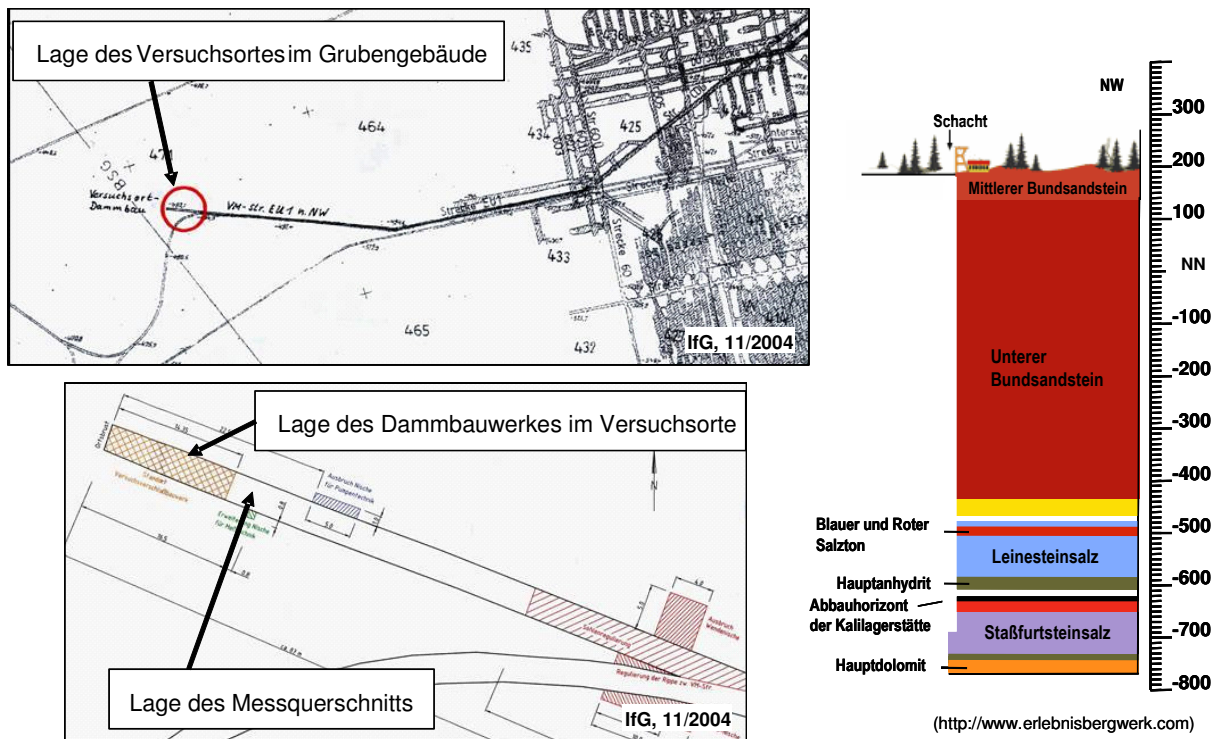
Oben links: Lage der in AP6a modellierten Untertagestrecke im Bereich der Maschinenstrecke EU1 der Grube Sondershausen; unten links: Ausschnittsvergrößerung der modellierten Blindstrecke vor dem Versuchsverschlussbauwerk [IfG, 2004]. Rechts: Übersichtsskizze der Gesteinsschichtung in und über der Grube Sondershausen, die Strecke EU1 befindet sich bei einer Teufe von 715 m im Stäufurteinsalz.
